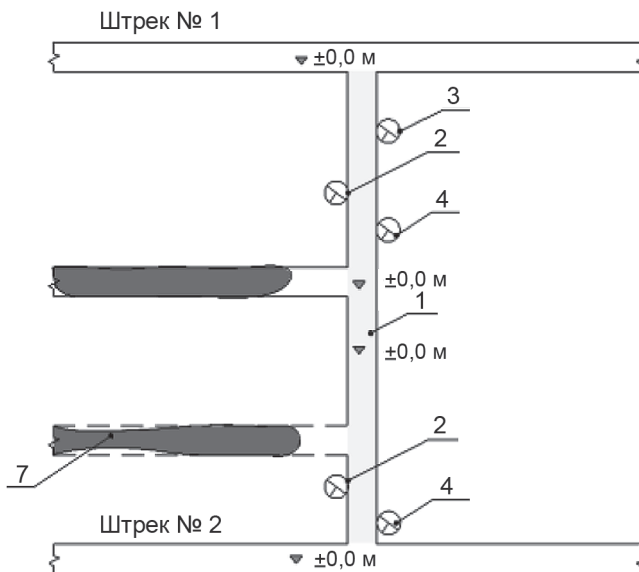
Отработка слоя № 1 – базовый слой: 1 – слоевой орт № 1 на уровне верхнего горизонта – вентиляционный орт; 2 – рудопуск; 3 – восстающий вент. ходовой; 4 – материальный восстающий; 5 – локальный съезд; 6 – разрезной орт; 7 – очистная заходка
